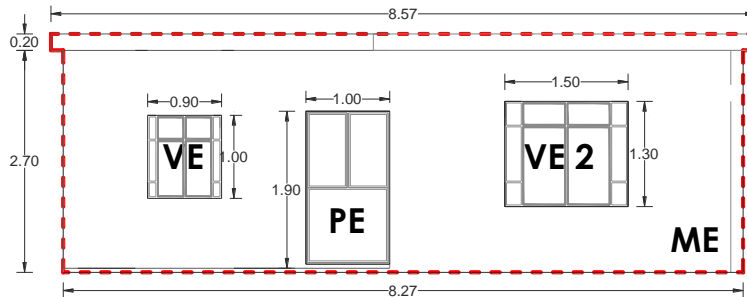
Fachada Este – F1. Fuente: Elaboración propia.
